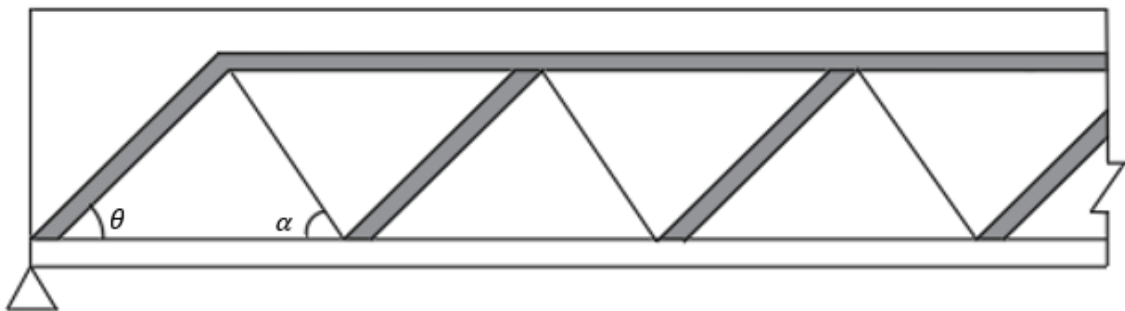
Ilustração de modelos de treliças associados a viga no estágio II para as considerações de z constante e z variável
